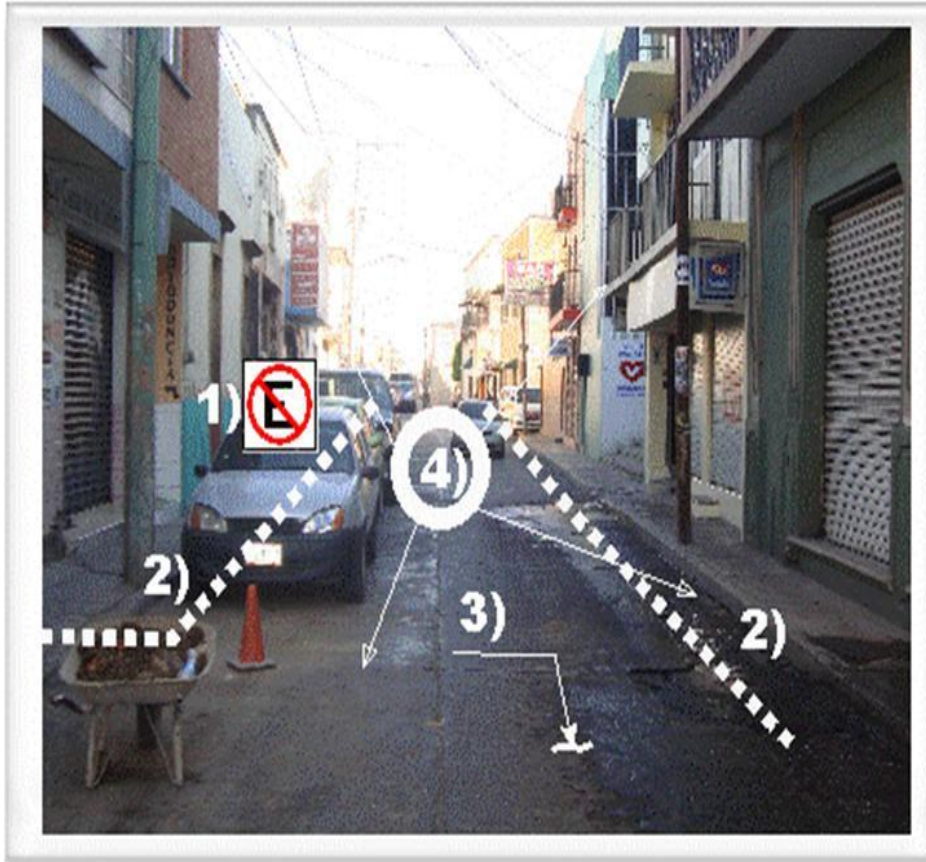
Propuestas planteadas en la estructura vial de la ciudad de Silao, especificando el horizonte de proyecto para su implementación. (fuente: CTV S.C.)
